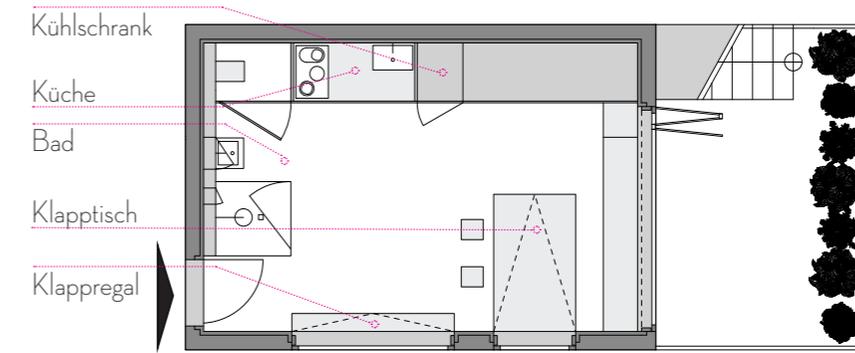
Grundriss:: Wohnzimmerlösung
